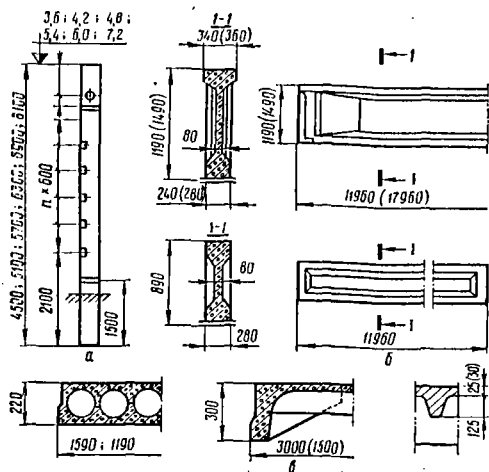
Элементы строительных конструкций: а — колонна сечением 400×400 мм; б — балки покрытий; в — плиты покрытий и перекрытий.
